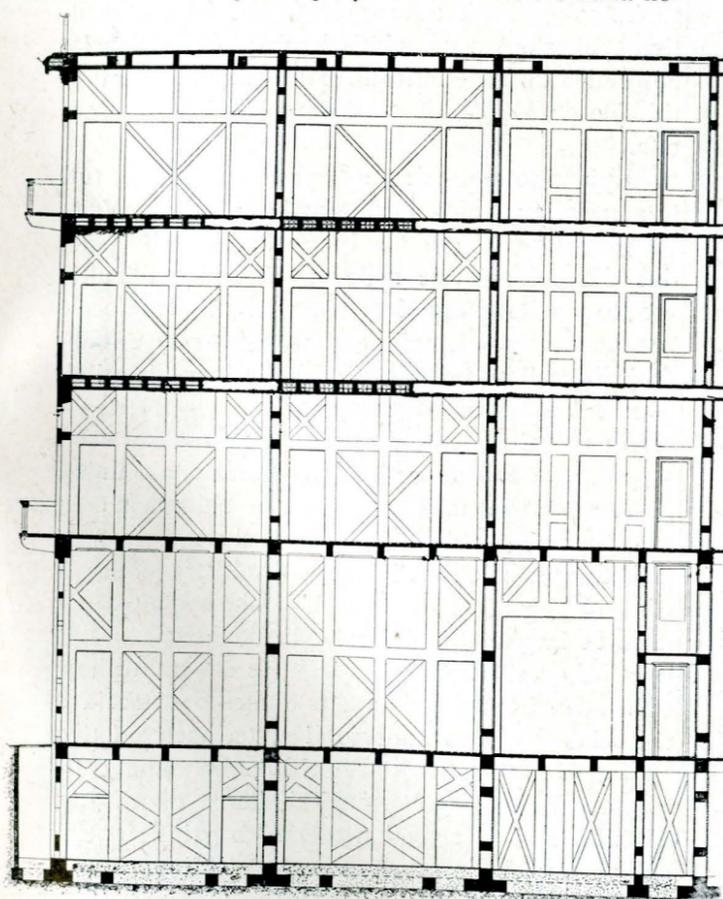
Sezione C-D e vista dello scheletro di un muro maestro assiale prima dell'applicazione del rivestimento in lamiera stirata. Scala 1:200
